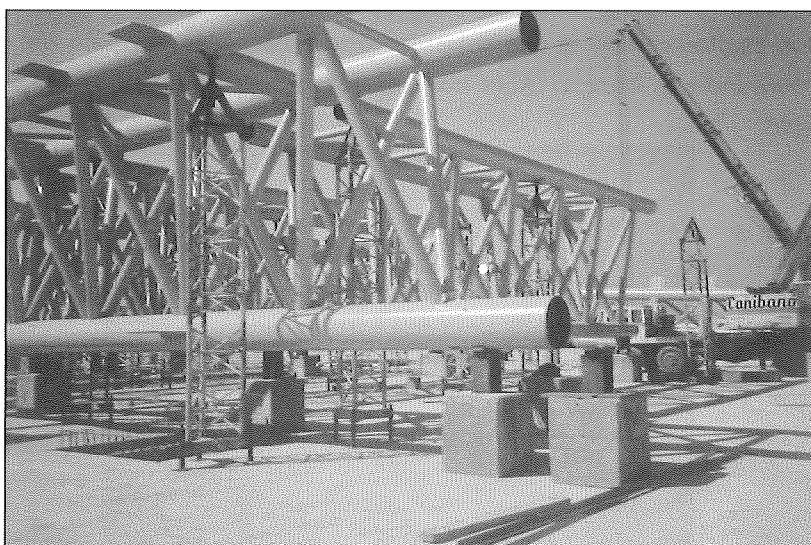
ELEMENTO DE VIGA ESPACIAL
